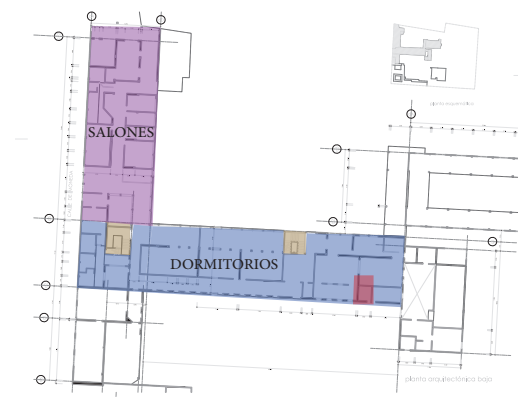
Zonificación de sectores en planta arquitectónica. FUENTE: Elaboración propia con planos obtenidos del CEFJR.
